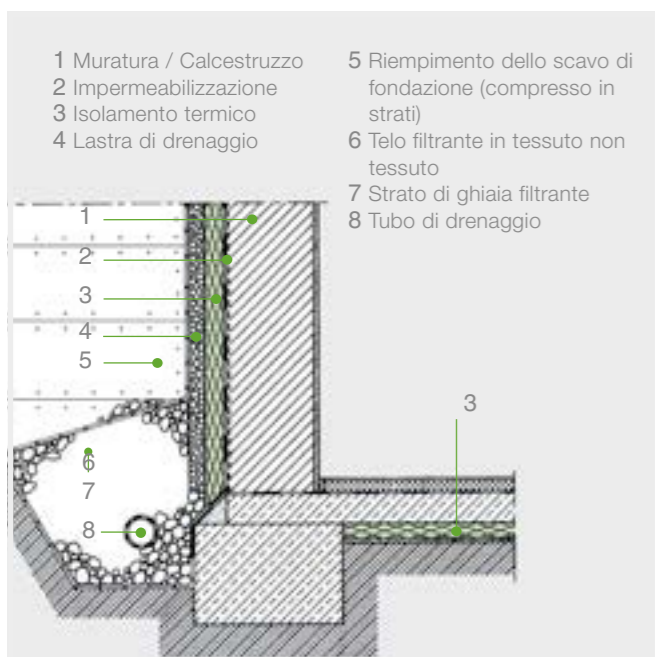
Struttura di un isolamento perimetrale combinato con un drenaggio.
